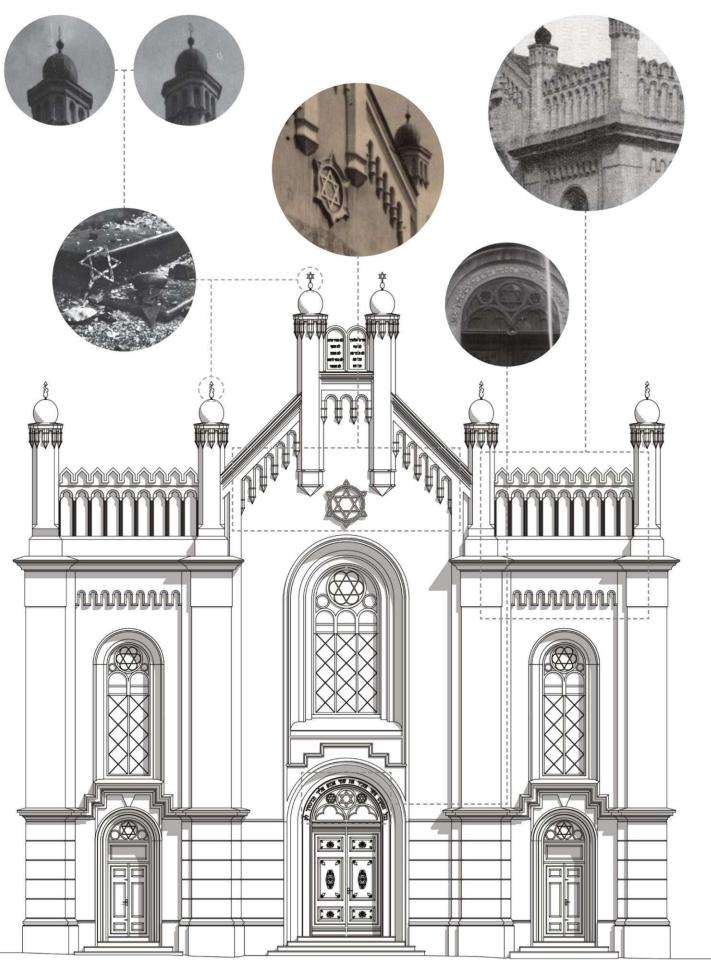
Ansicht der rekonstruierten Westfassade mit Detailfotografien
